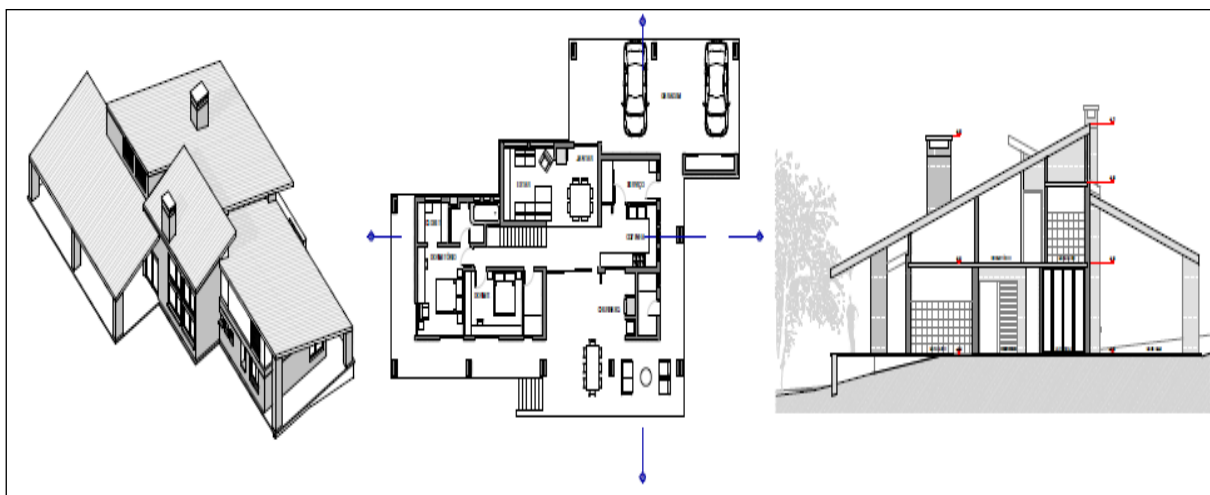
Modelo tridimensional confeccionado no ArchiCad: modelo 3D, planta e corte
